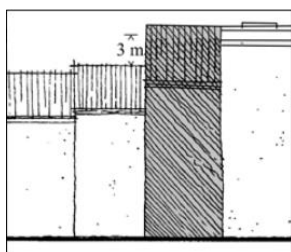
Exemple de cas non conforme avec le RRU en vigueur (alternative « zéro ») et conforme avec le projet de modification du RRU (Source: Titre I du RRU)
